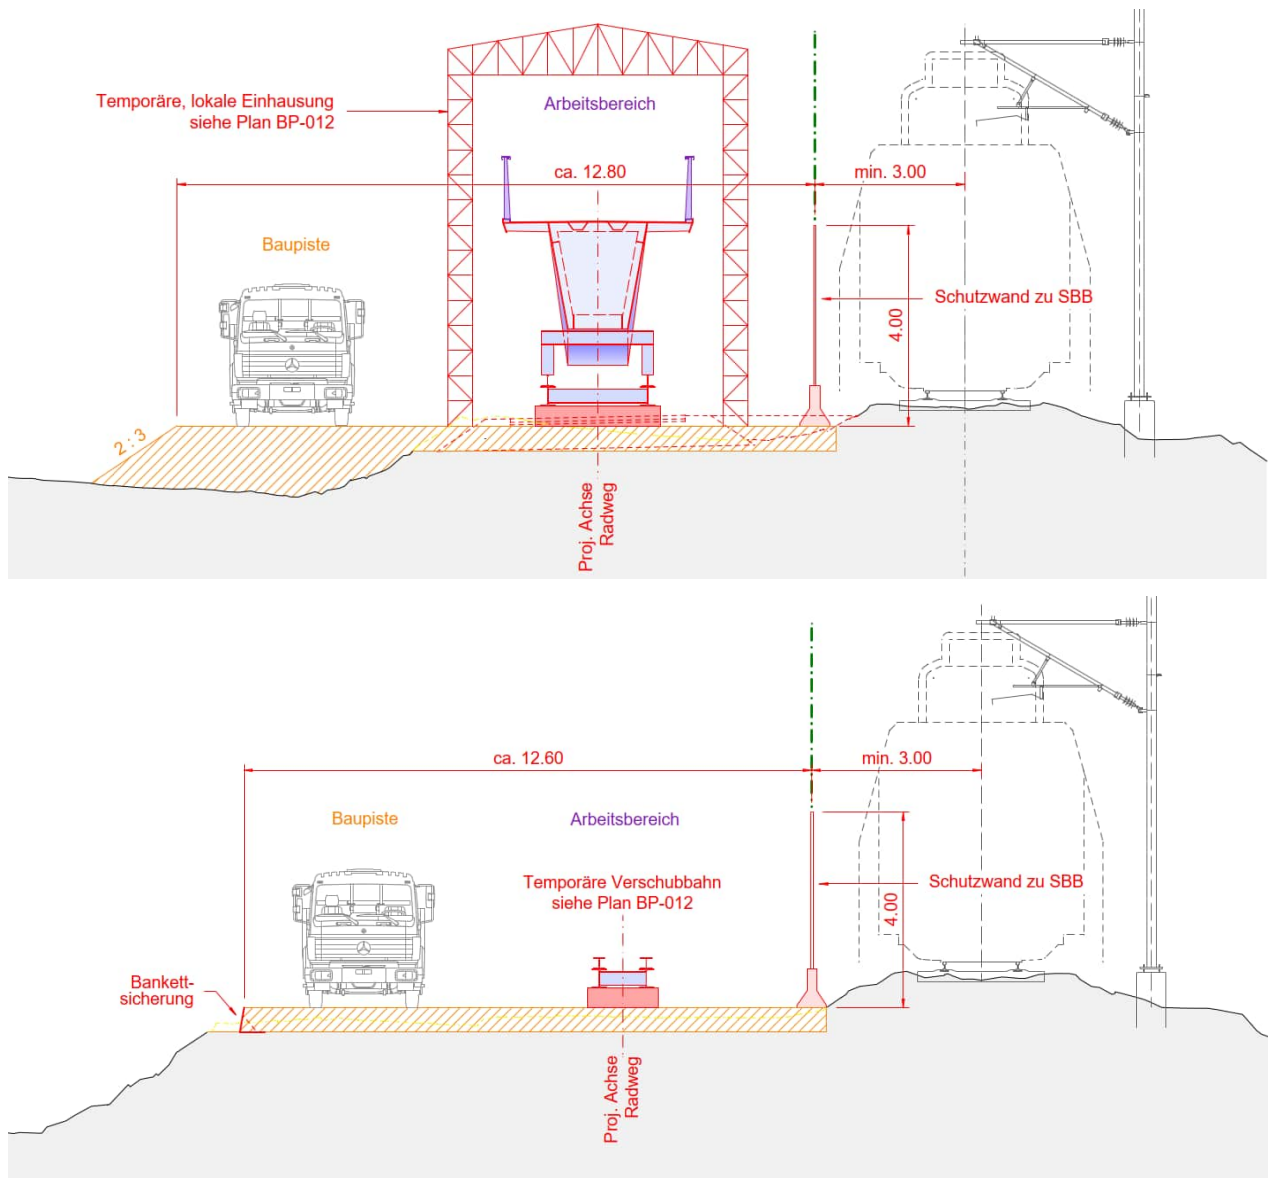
Ausschnitt Installationsplan, Schnitt A-A (oben) und Schnitt B-B (unten), Schnitt-Standorte gem. Abbildung 25.
